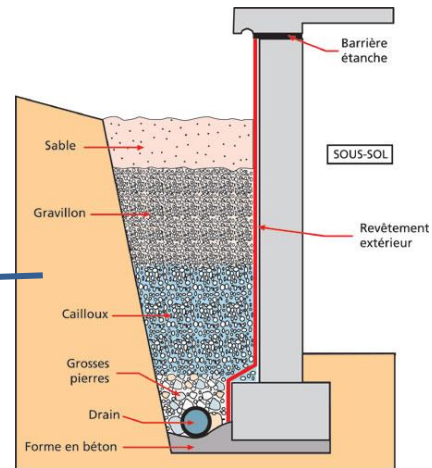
Détails du mur de soutènement du sous-sol/Source : <httpswww.batirama.com>
